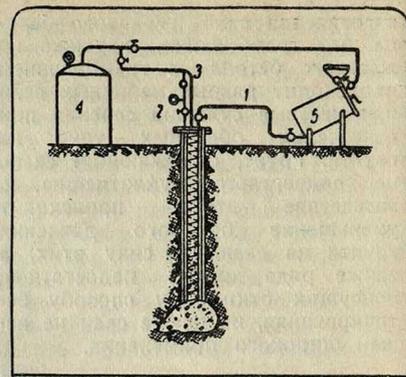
Схема бетонирования пневмонабивных свай по методу Вольфсгольца: 1, 2 и 3 — трубки, соединяющие скважину с наружным воздухом, бетономешалкой и баллоном сжатого воздуха, 4 — баллон сжатого воздуха, 5 — бетономешалка.
